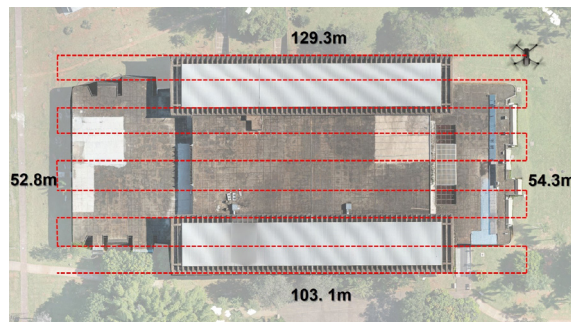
Plano horizontal adotado e linhas de voo automático.
